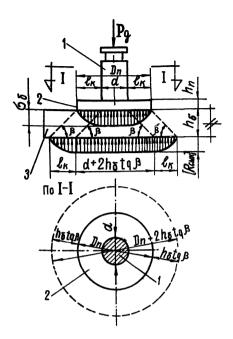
У.6. Расчетная схема стальной опорной плиты, расположенной в средней части стены на двухслойном основании: 1-домират; 2-опорная плита; 3-железобетонная подушка
